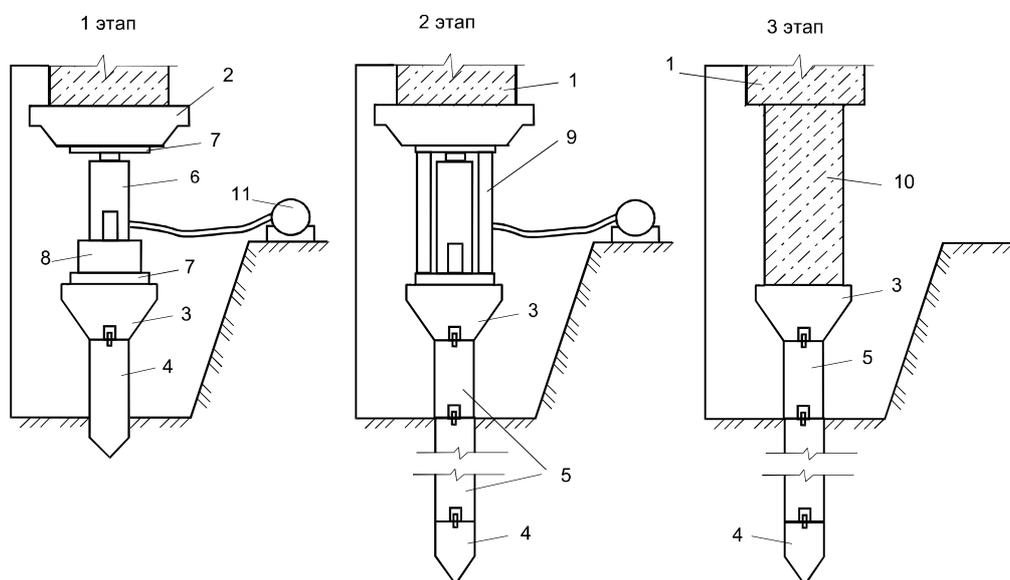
Этапы (1...3) работ по усилению фундаментов сваями типа «МЕГА»: 1 – существующий фундамент; 2 – распределительный элемент; 3, 4, 5 – головной, нижний и рядовой элементы сваи; 6 – домкрат; 7 – стальные пластины; 8 – подкладки; 9 – подпорки; 10 – распределительная балка; 11 – гидронасос
